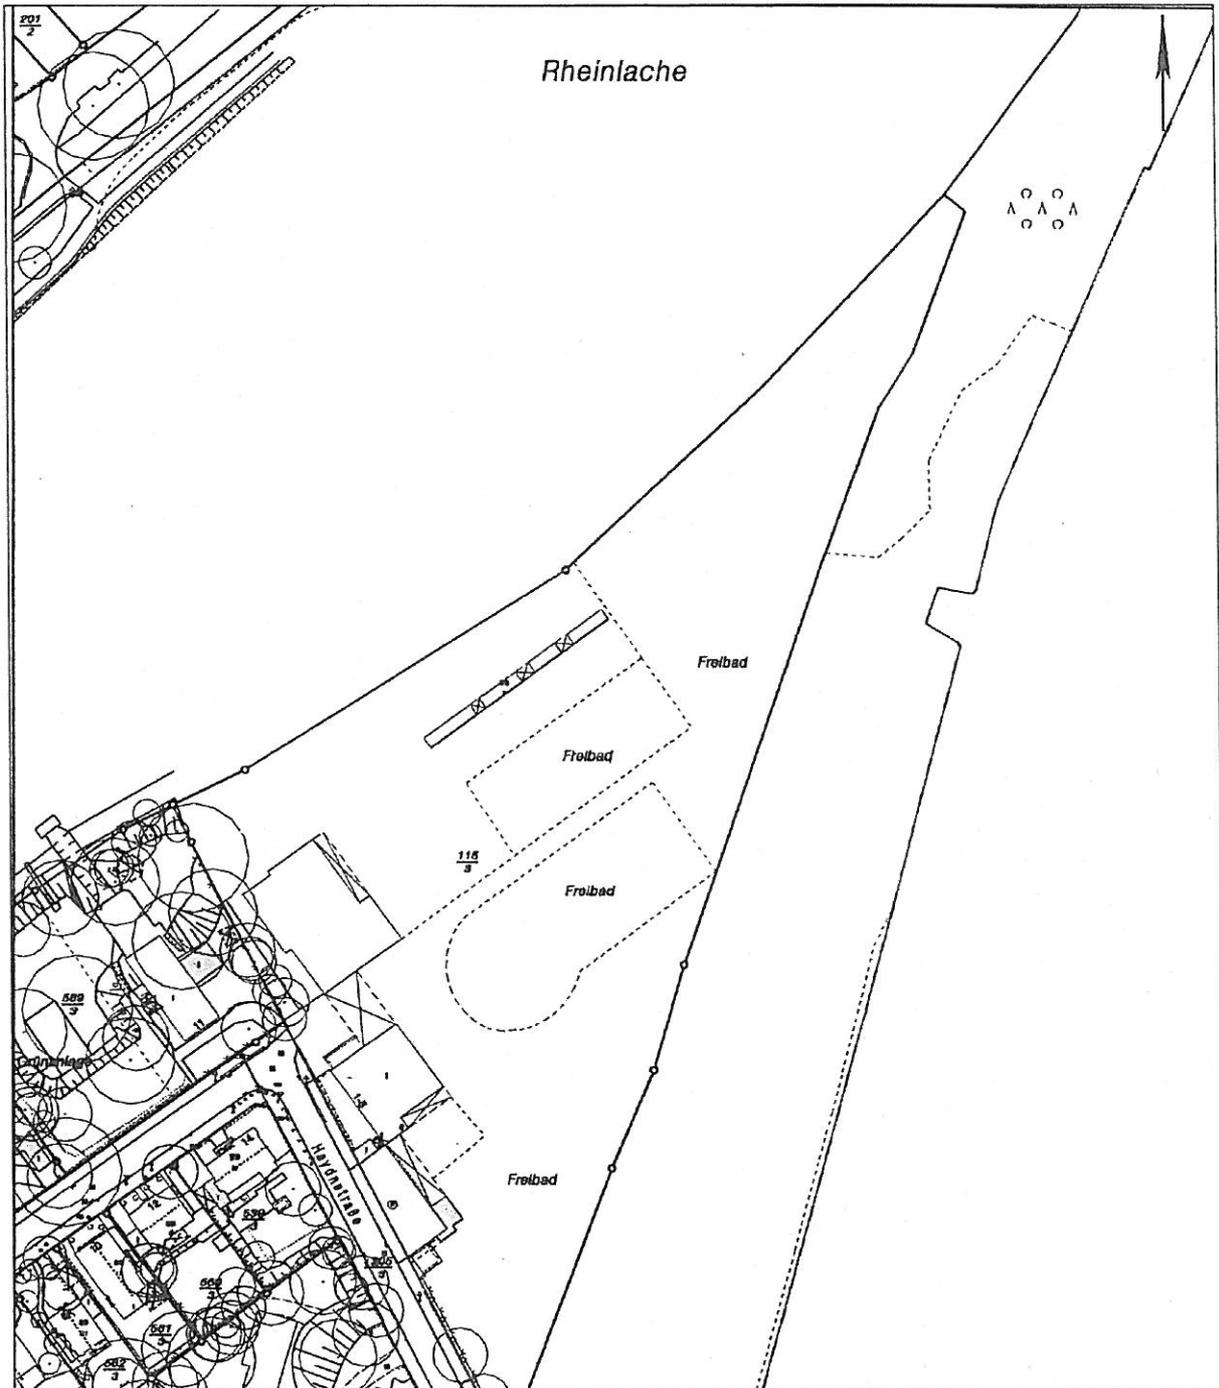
Lageplan externe Ausgleichsfläche gemäß Nr. B 4.2
